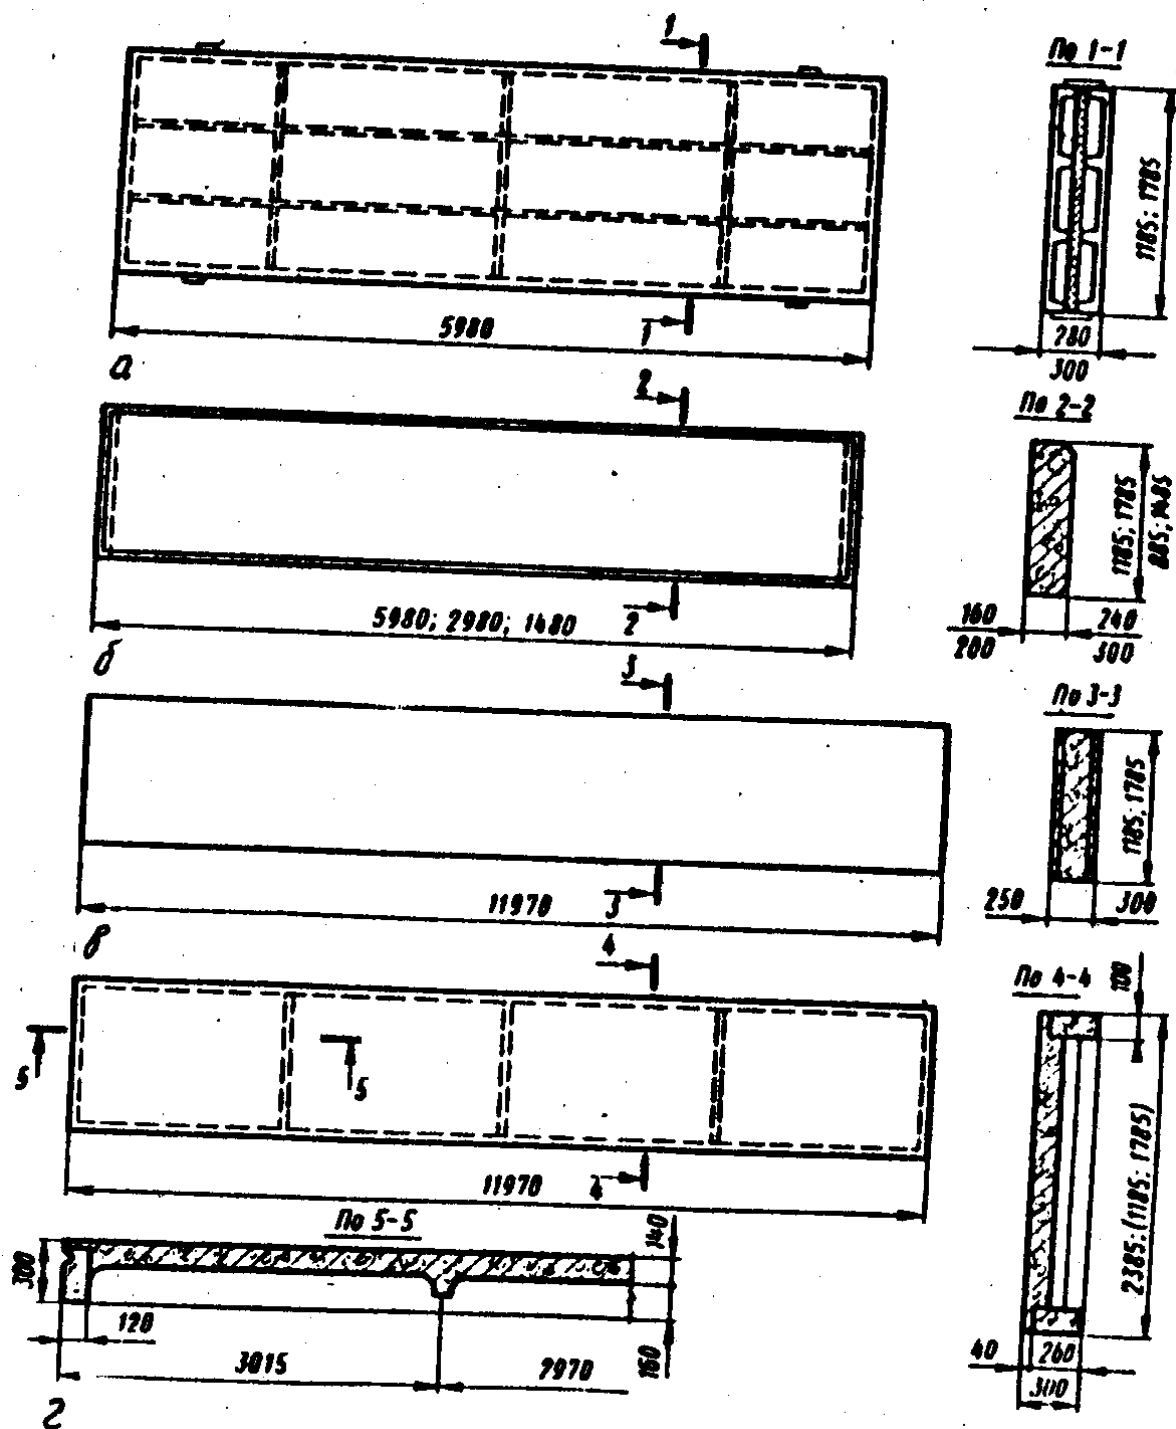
Схемы панелей для стін опалювальних будівель:
